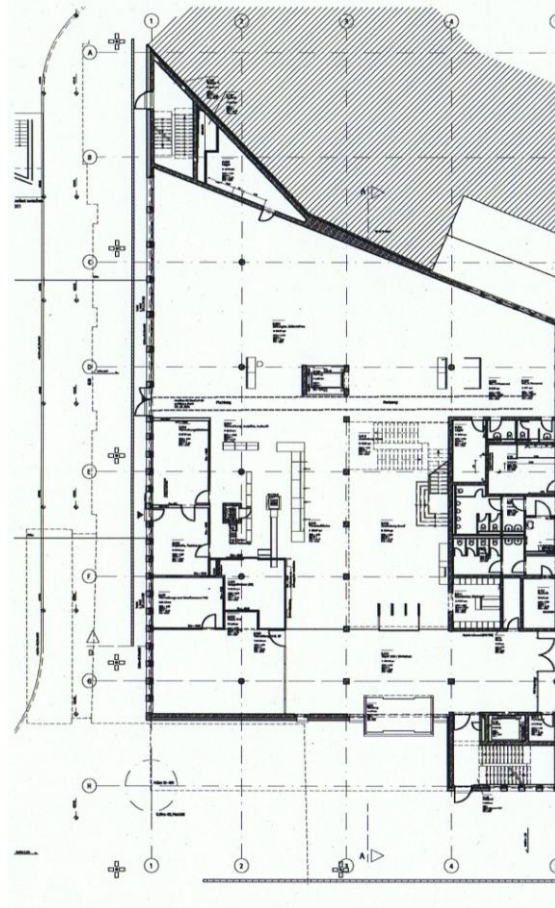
Grundriss 1.Obergeschoss Zentralbibliothek Hamm
